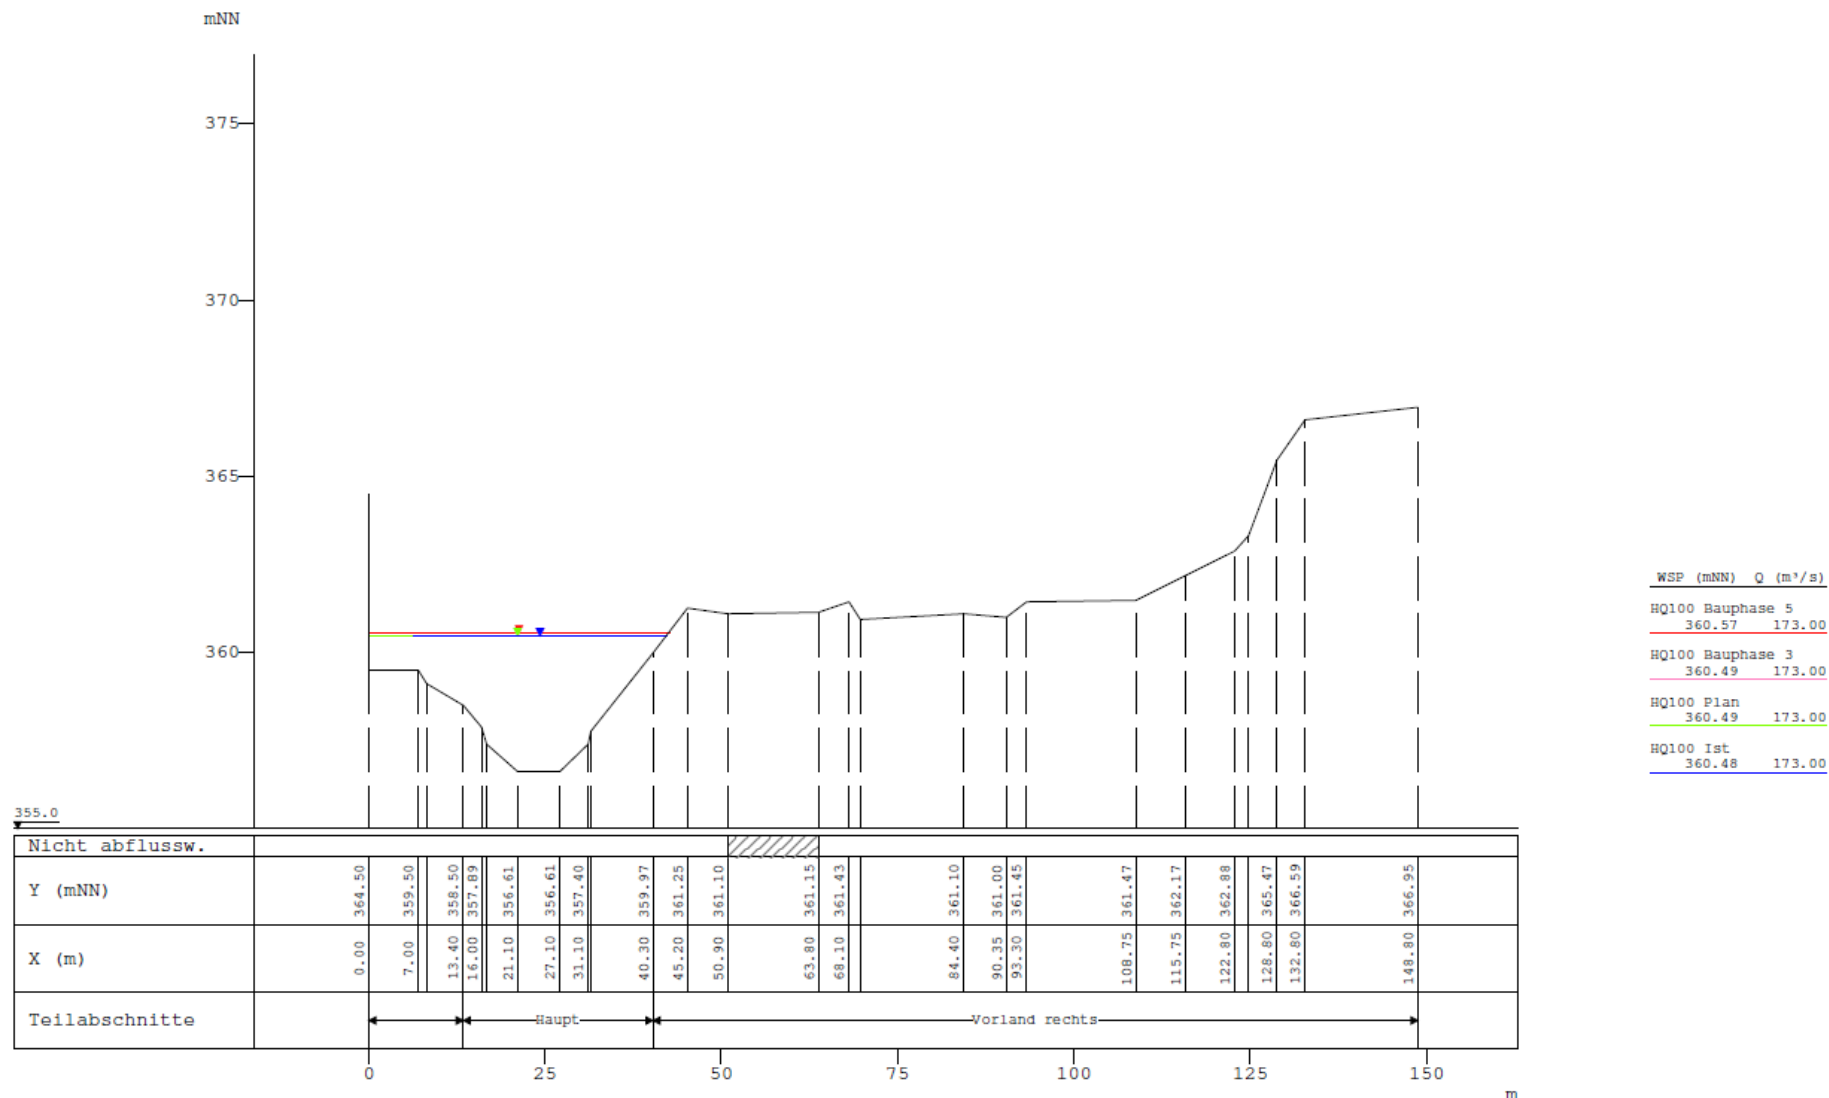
Querprofil 82110 (direktes Oberwasser Brücke B410) inkl. Wasserspiegellagen HQ100 Istzustand, Planzustand, Bauphase 3 und Bauphase 5; Geometrie Planzustand
